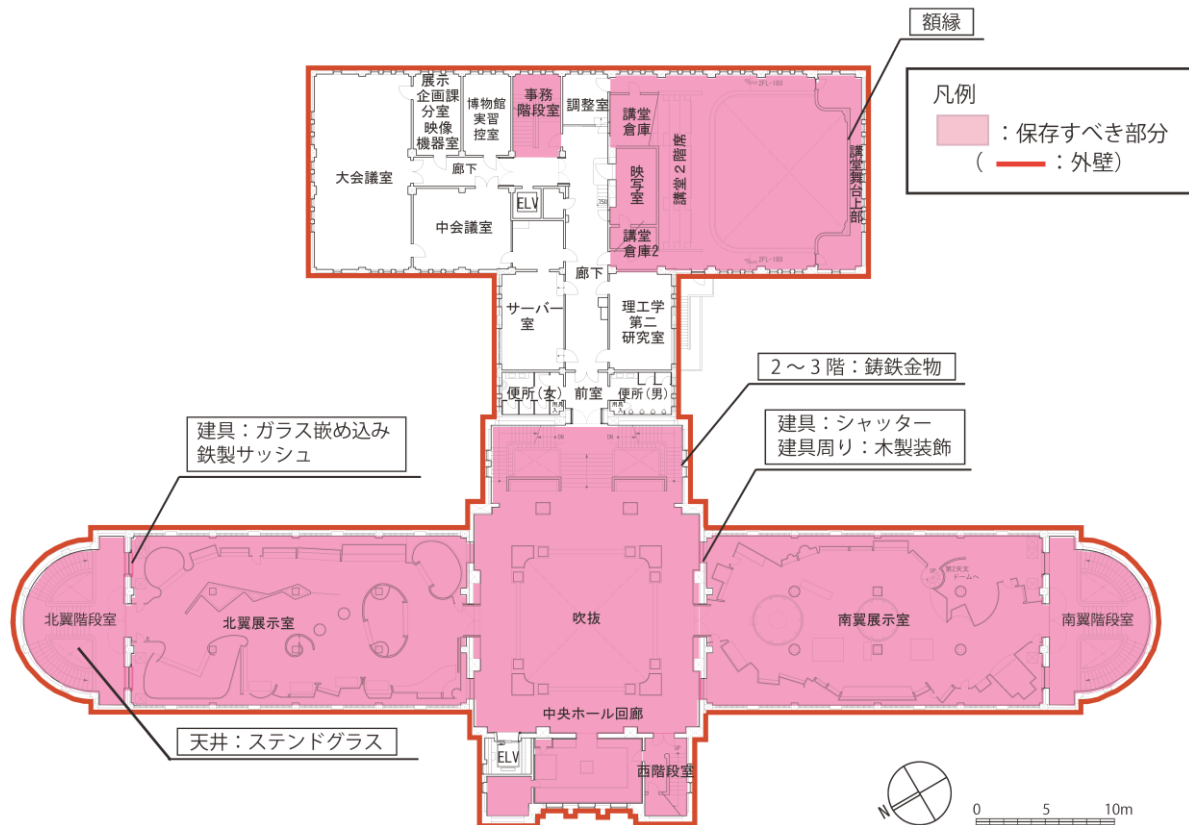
保存すべき部分 3階平面図 (改修前3階平面図に加筆)
